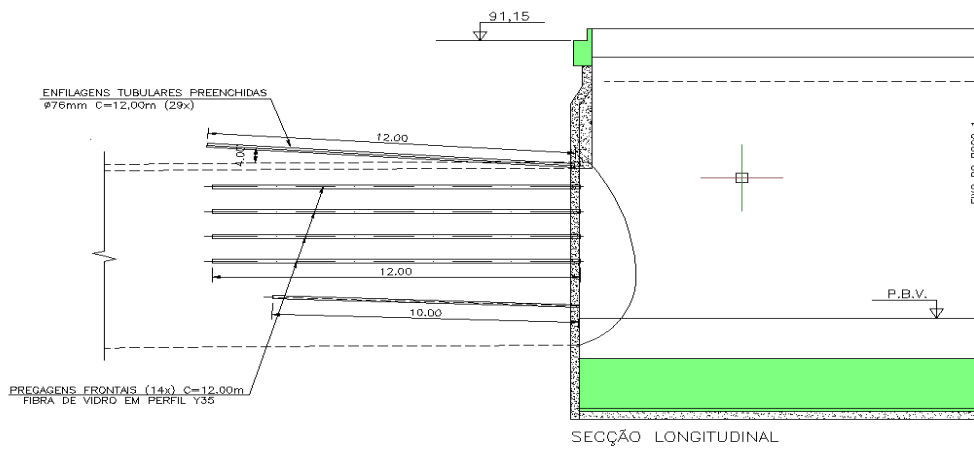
Perfil longitudinal do emboquilhamento do túnel norte (Adaptado CJC, 2008).
